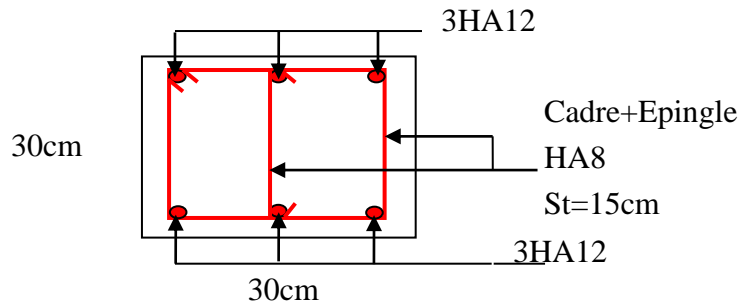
Schéma de ferrailage de la poutre de chaînage
